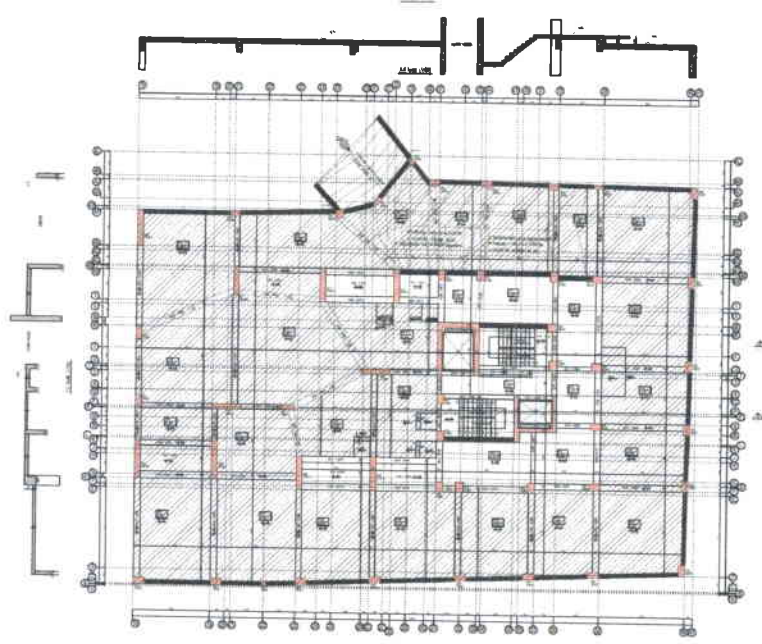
A2 blok Zemin-7.Kat Kalıp Planı
